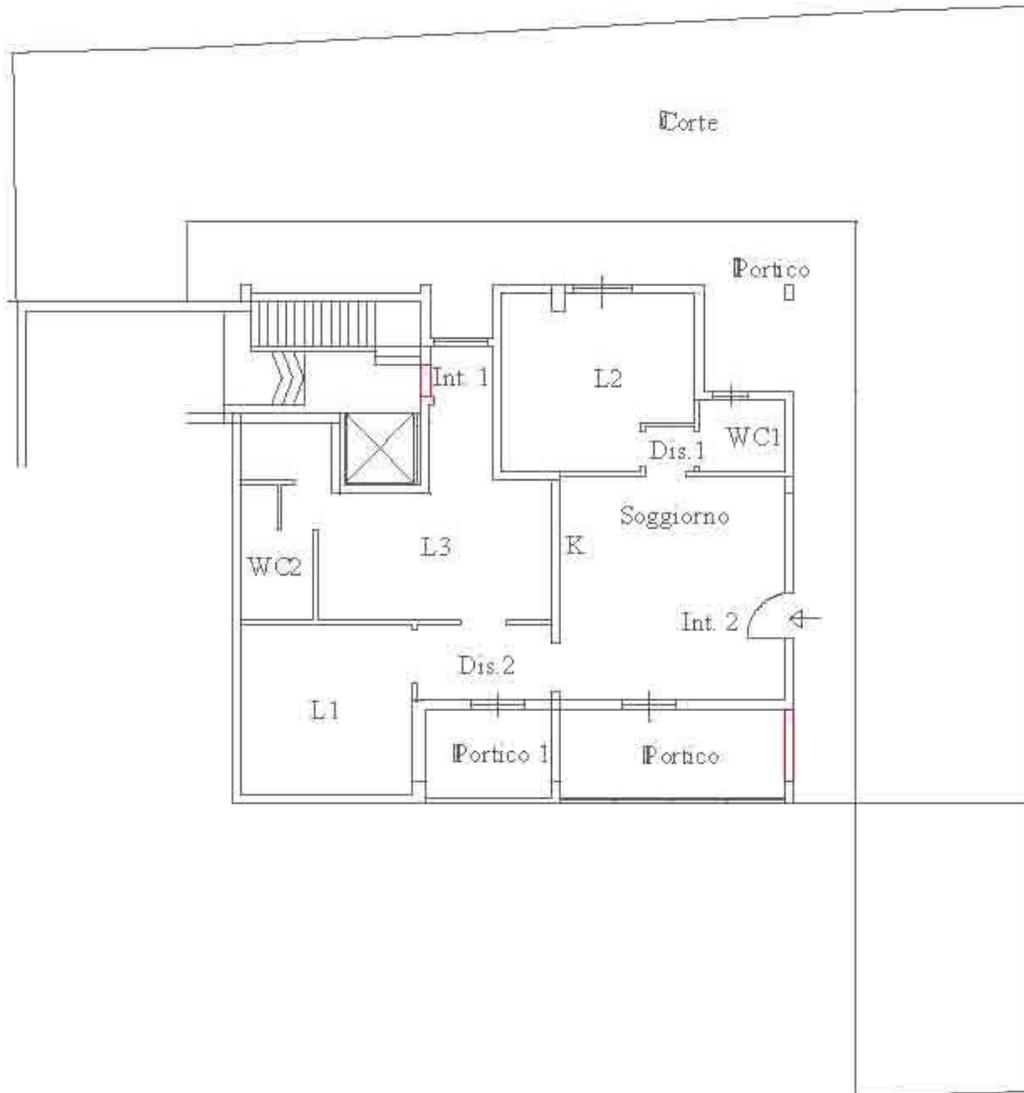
LOTTO N. 1 - RILIEVO METRICO APPARTAMENTO
